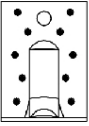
Przekroje fragmentu konstrukcji stropu drewnianego
